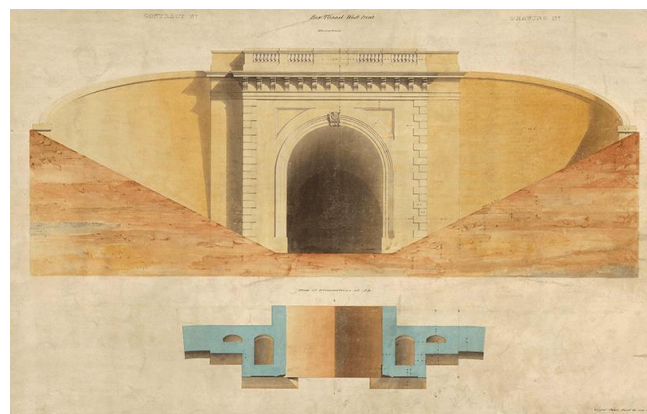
I.K. Brunel, *Great Western Railway, Box Tunnel West front, Pianta e prospetto*. (Network Rail Archive, NRCA110034).
